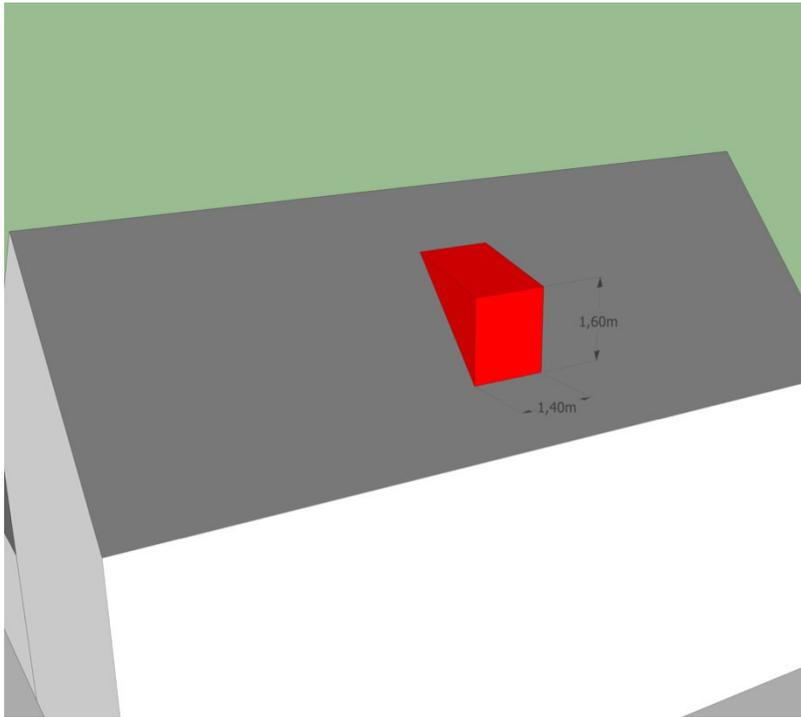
Mindestabstand des Dacheinschnittes zum Giebel bei giebelständigen Gebäuden gem. § 9 Abs. 4
